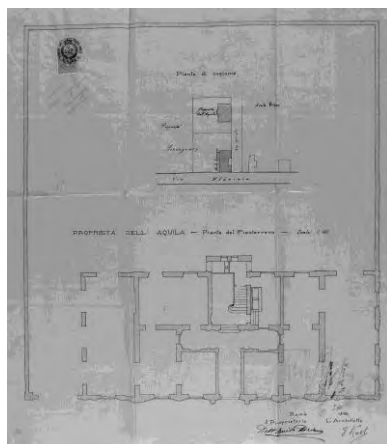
villino dell'Aquila planimetria generale e pianta del piano terreno
